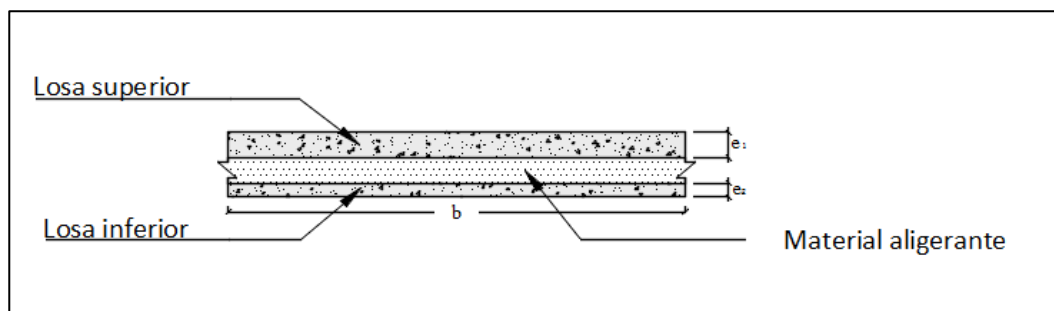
Sección transversal de análisis de losa con panel estructural
